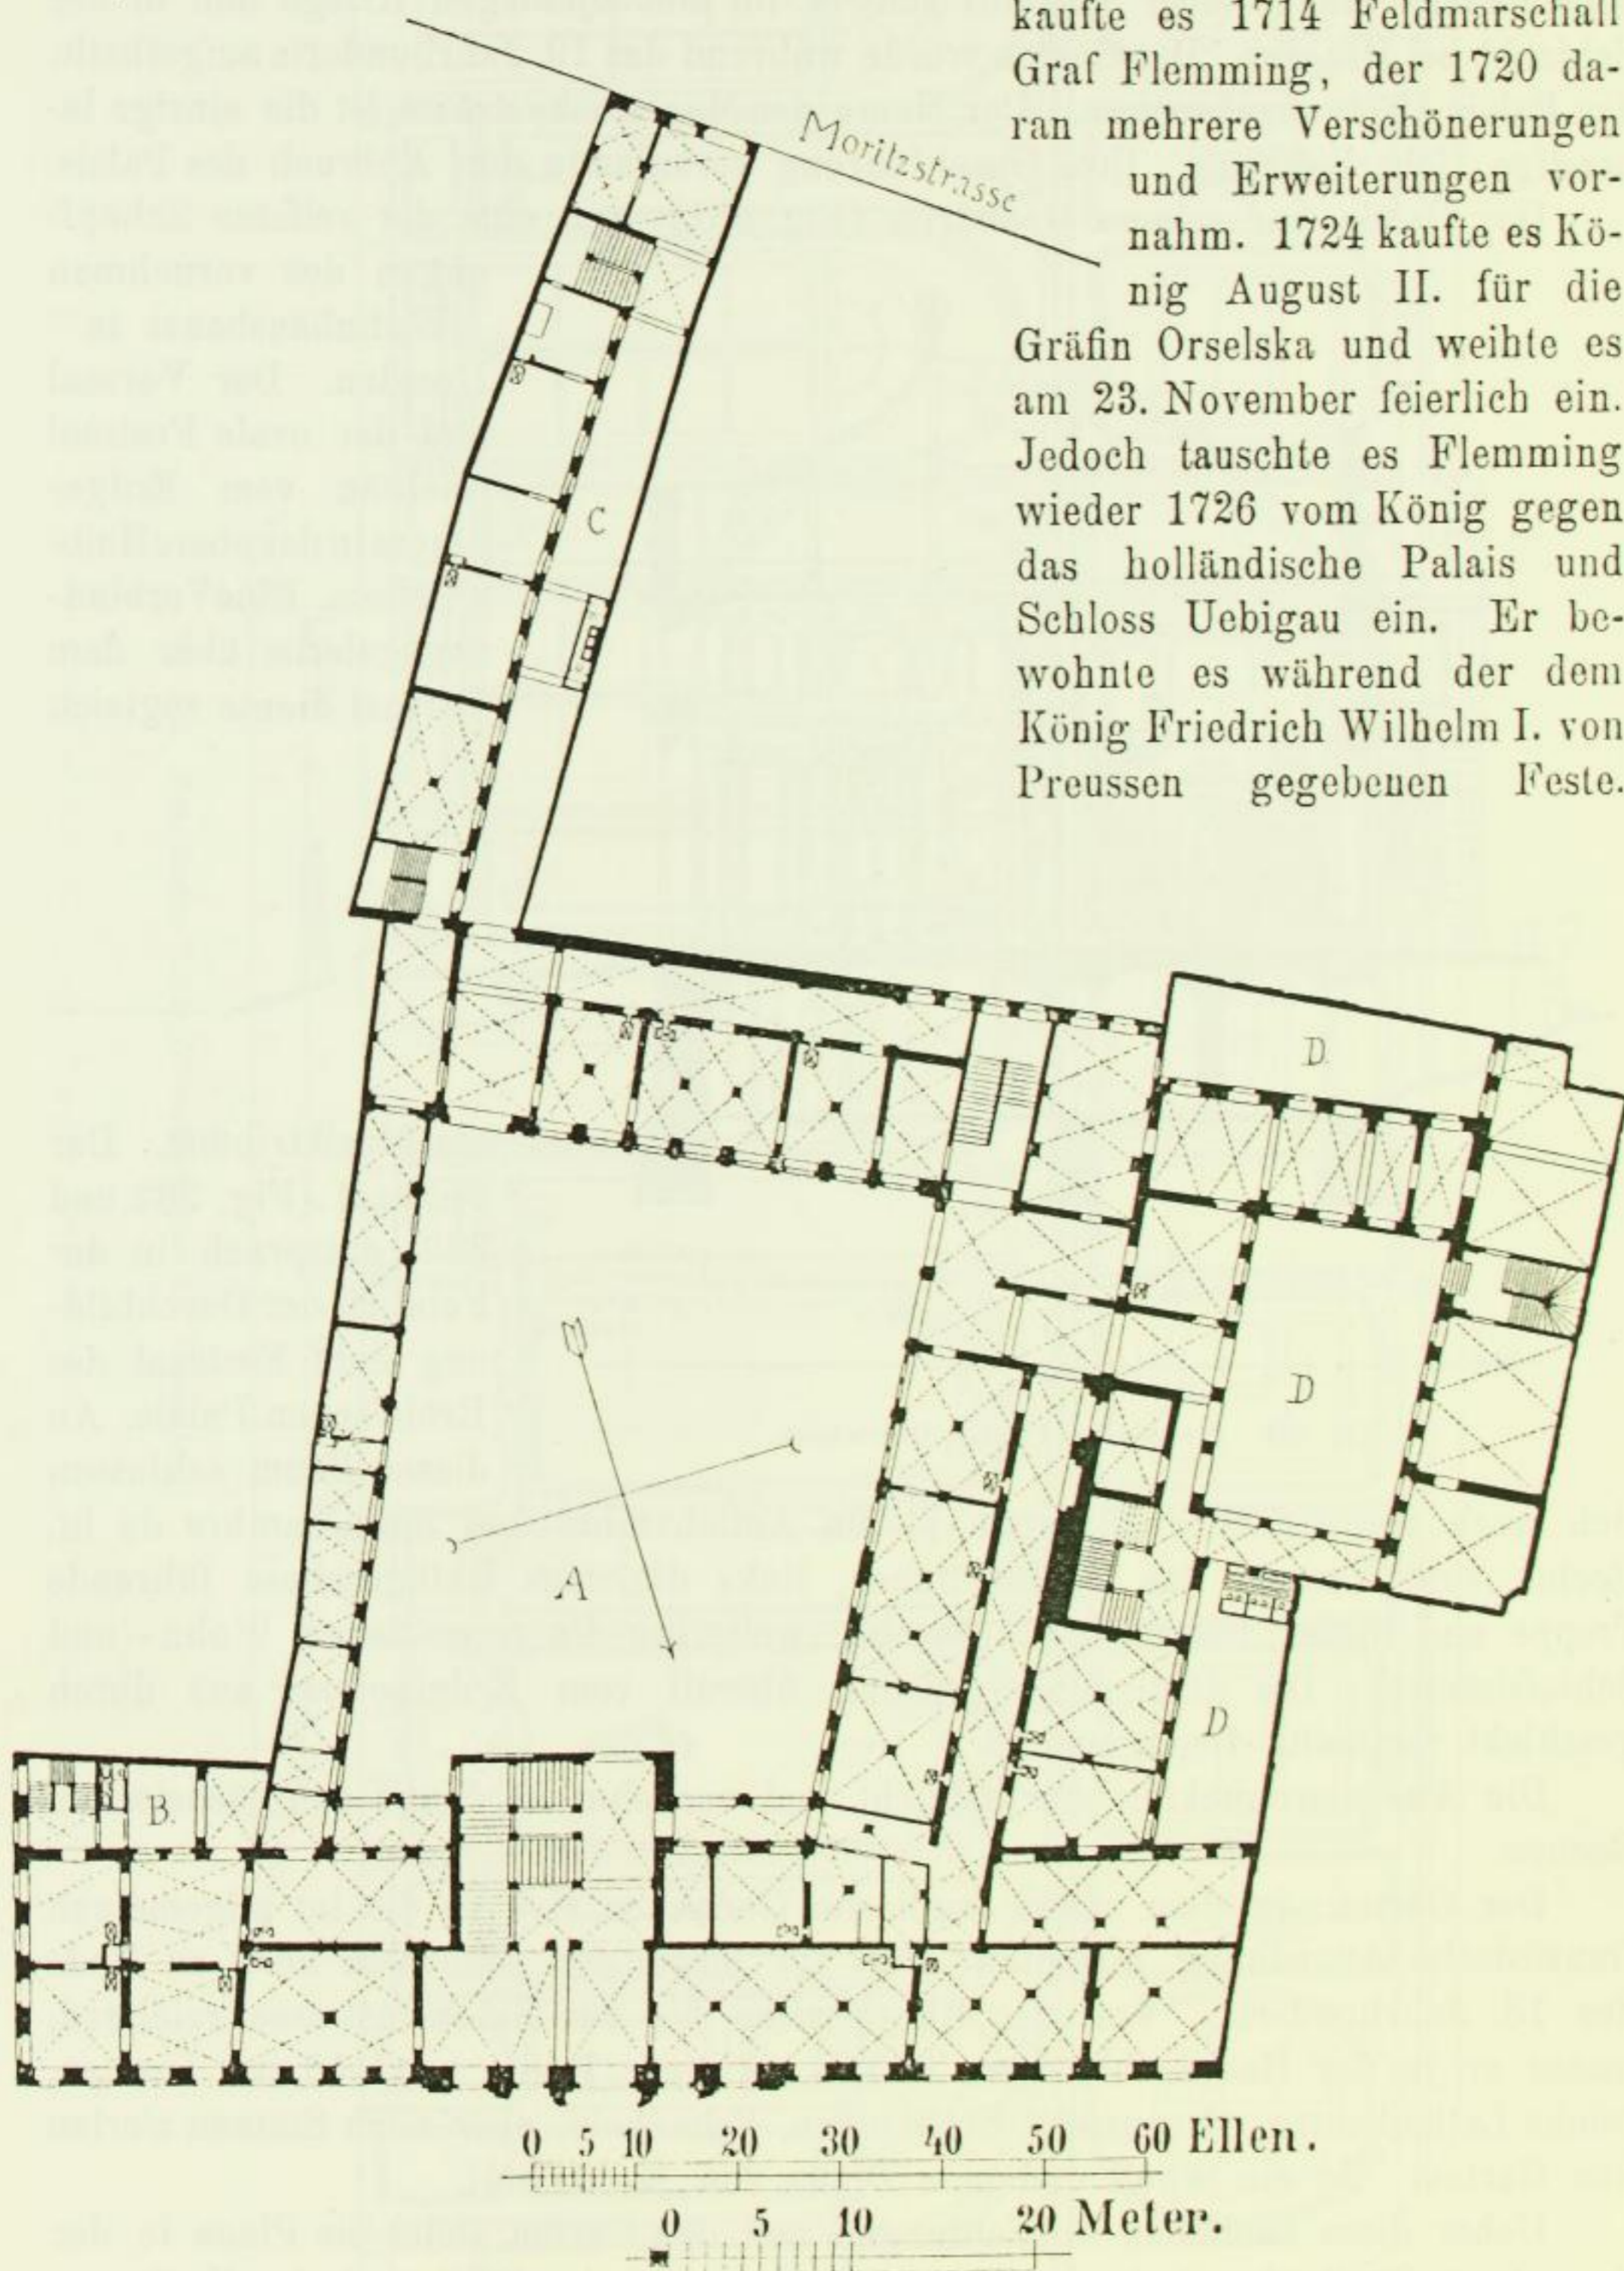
Flemming'sches Palais, Grundriss des Erdgeschosses. Zustand von 1747.
